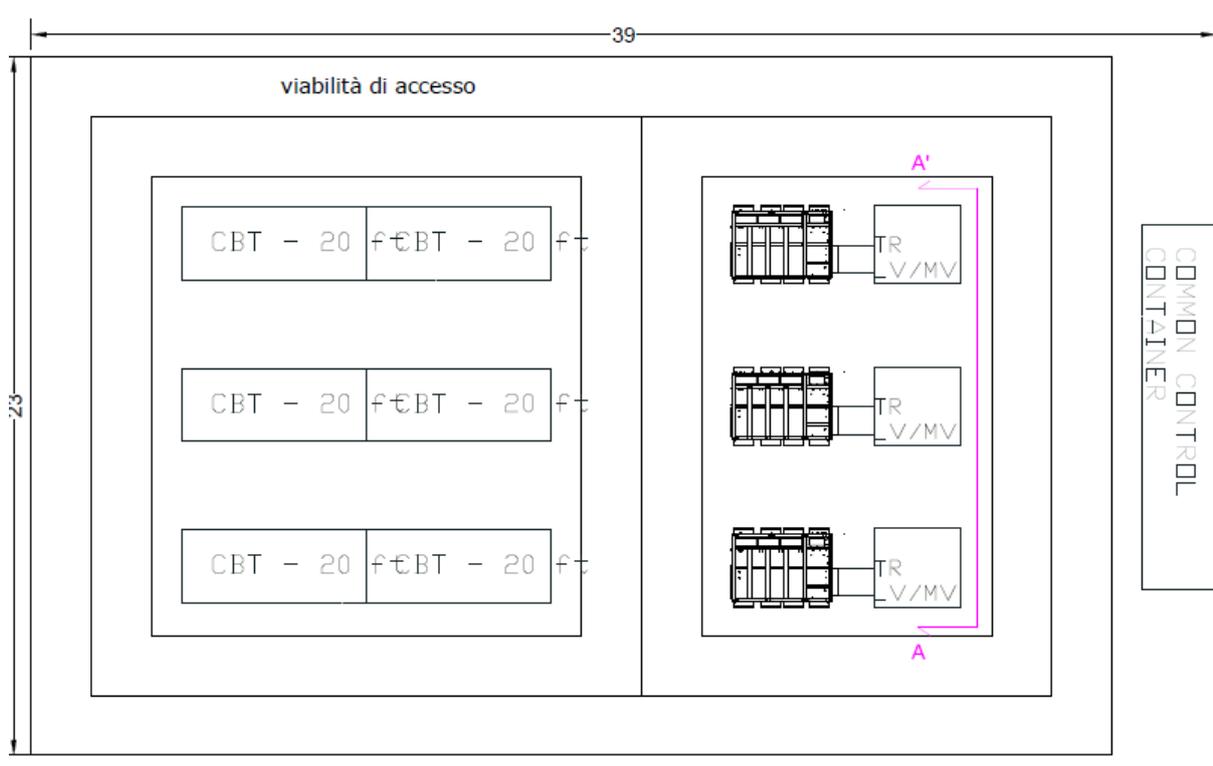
planimetria elettromeccanica dell'impianto di Accumulo Elettrochimico di cui alla presente variante.
